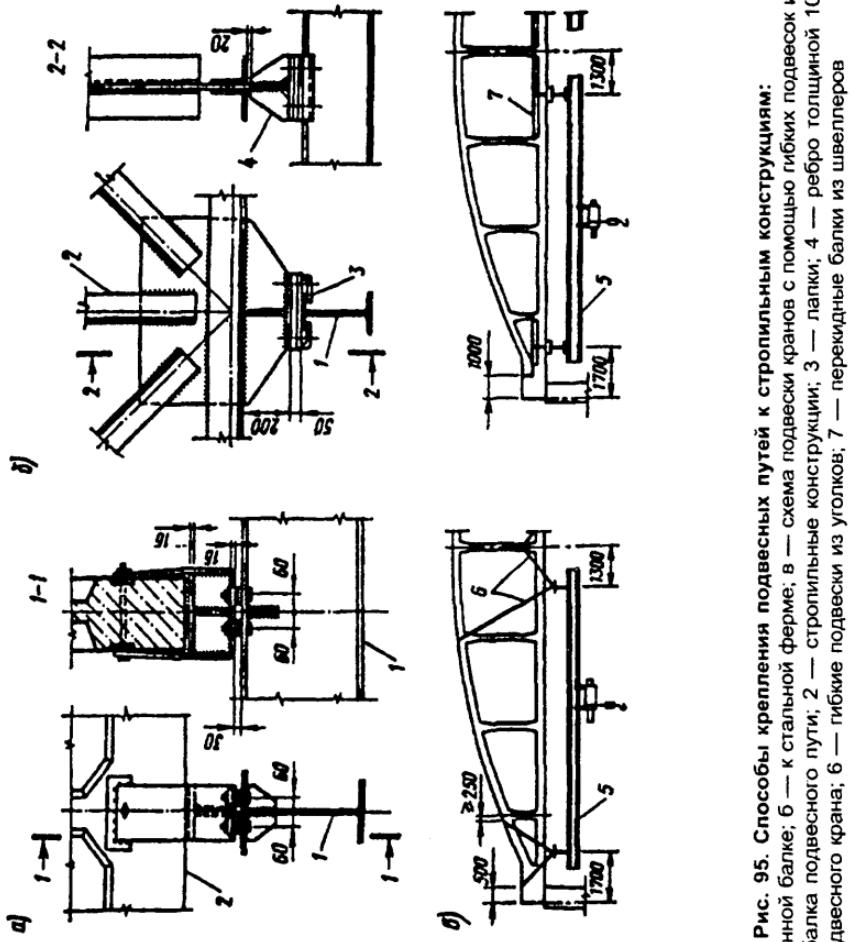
Способы крепления подвесных путей к стропильным конструкциям:
